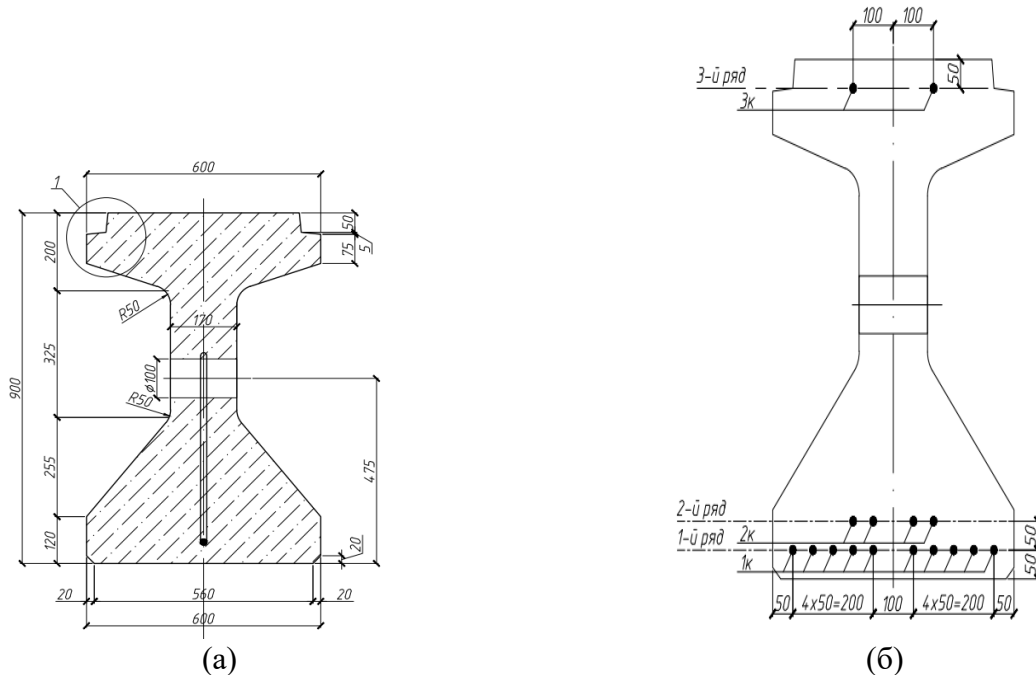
Поперечний переріз балки: а – габаритні розміри, б – армування
